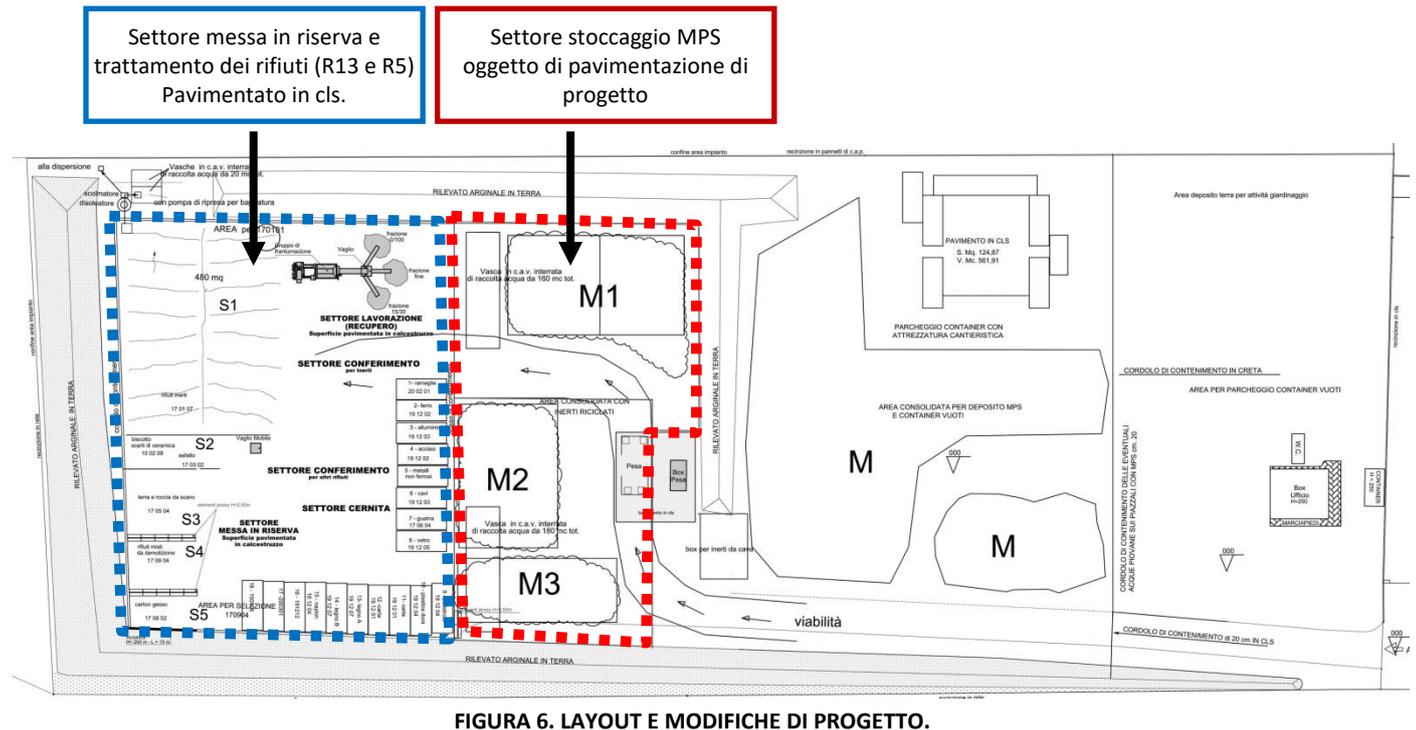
LAYOUT E MODIFICHE DI PROGETTO.
